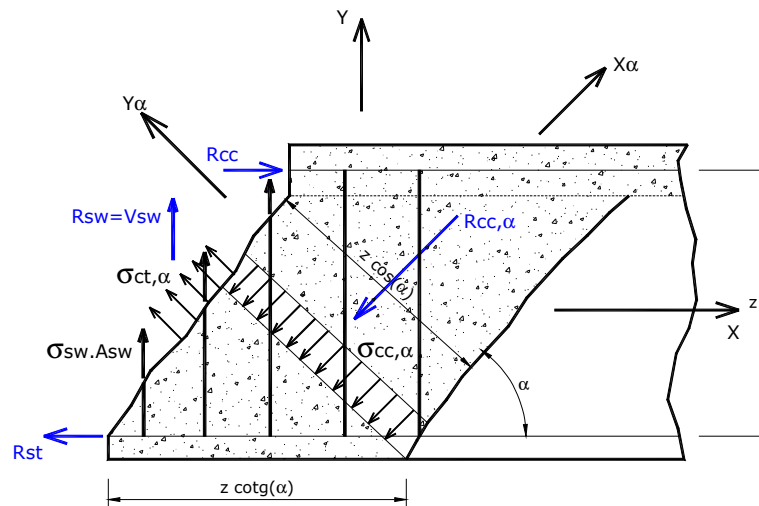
Estado de deformação para as bielas de concreto e armadura transversal
